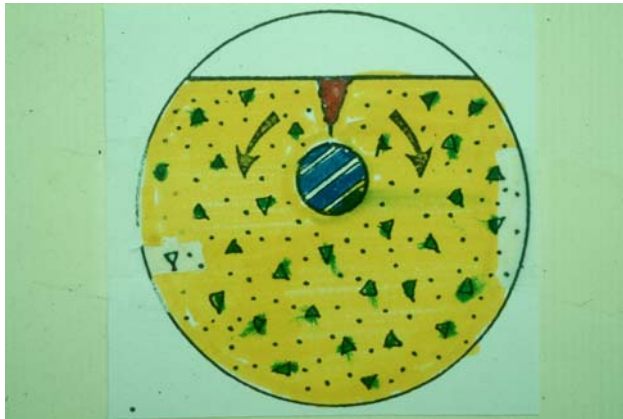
A retração do concreto ao redor da armadura pode causar a fissuração.
